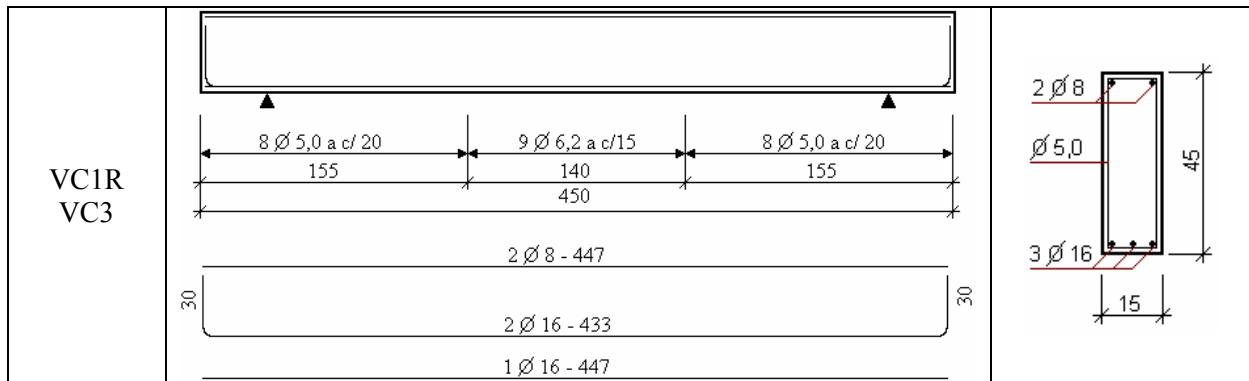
Armaduras das vigas do experimento de ARAÚJO, C.M. (2002)
